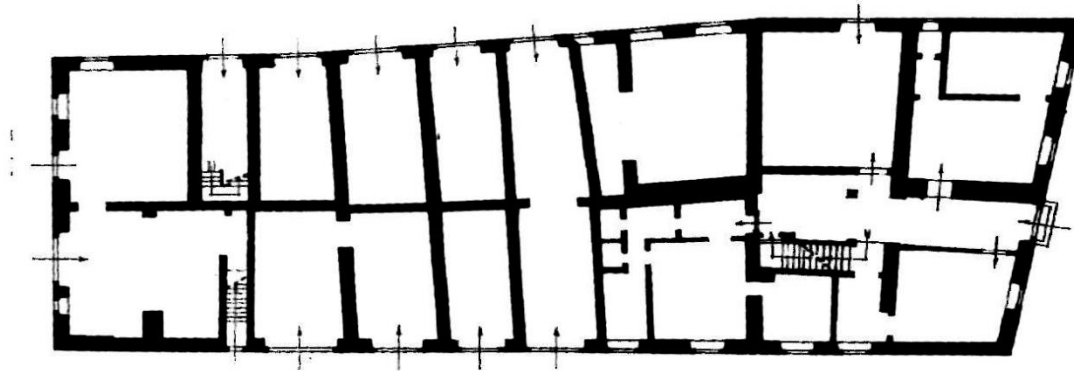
Edificio centro storico di Firenze, pianta piano terra anno 1950.
